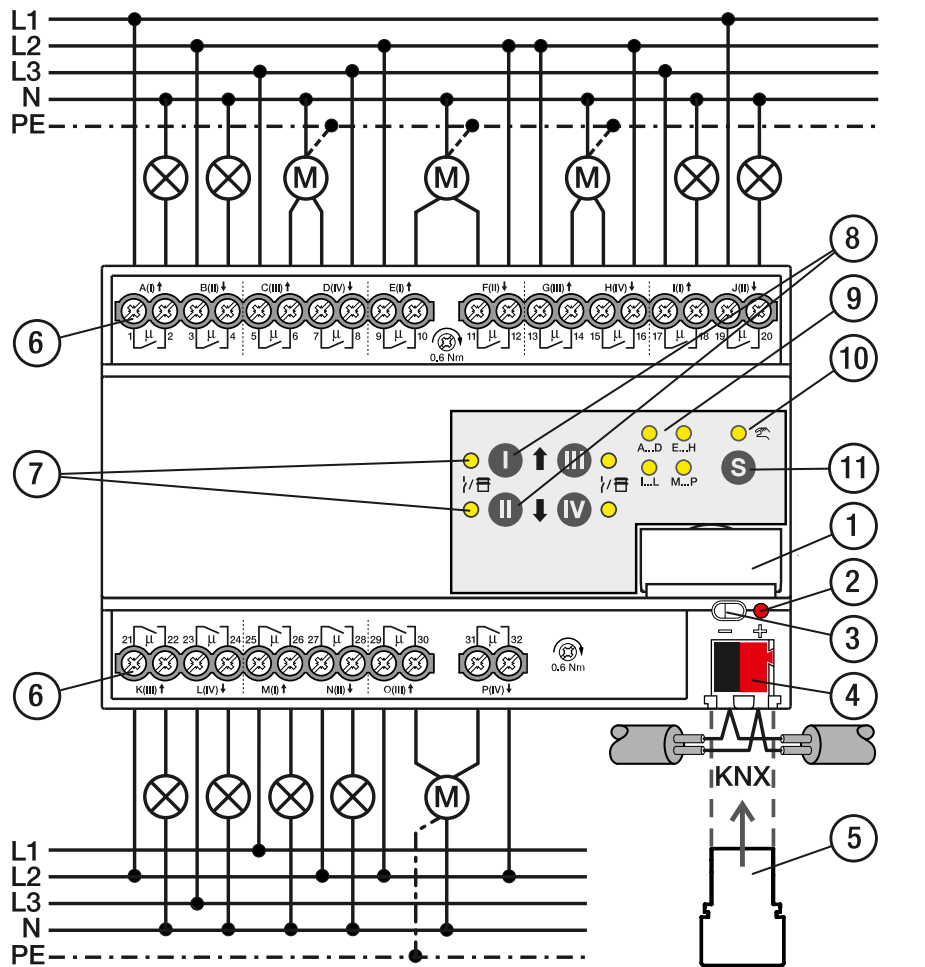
Schema di collegamento SAH/S 16.x.7.1
